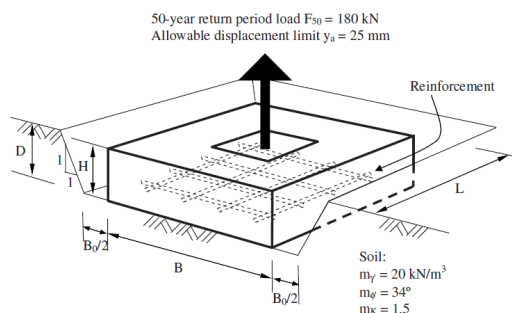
Modelo de cálculo zapata. Wang [143].
